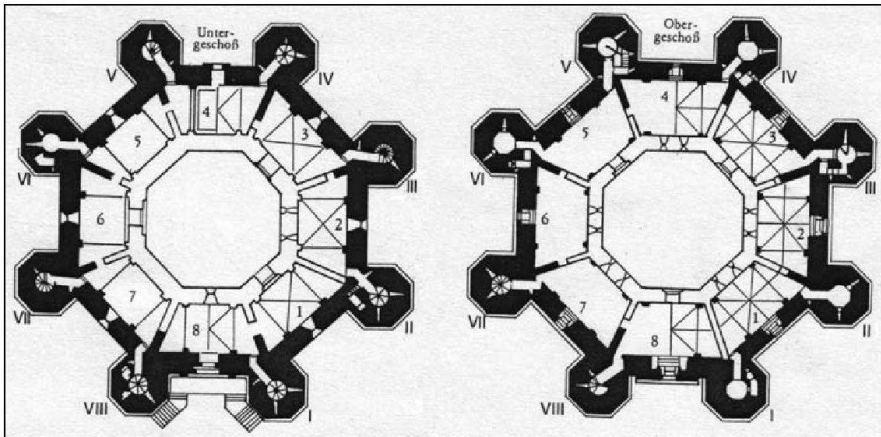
Castel del Monte, Apulien, Grundriss.
